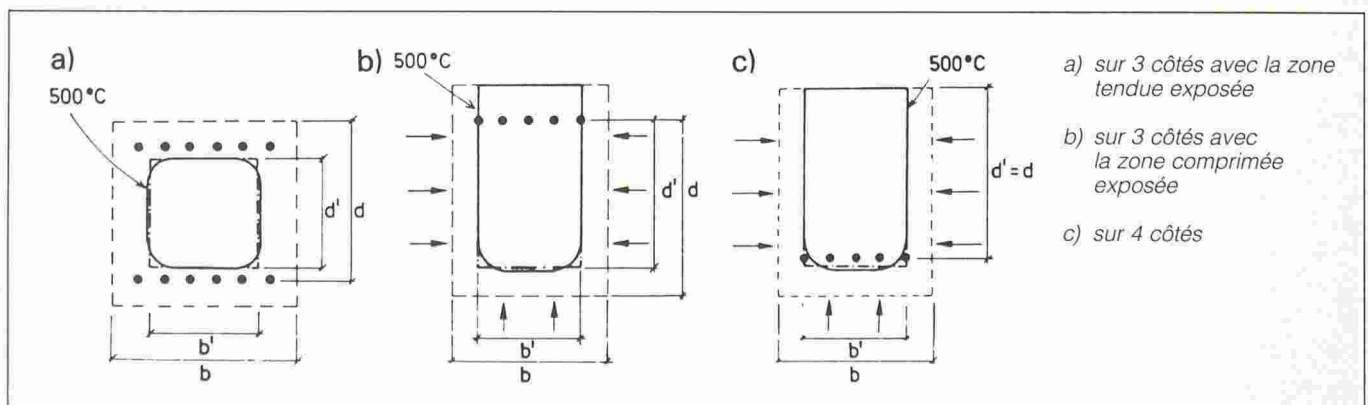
Sections réduites d'une poutre en béton armé exposées au feu.
